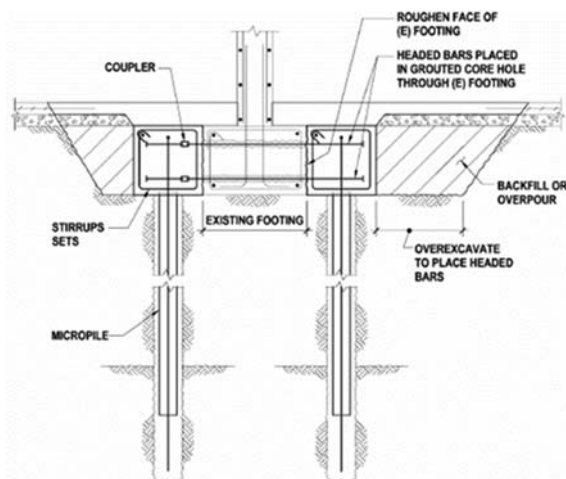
Recalce con micropilotes. Unión encepado-zapata existente mediante armadura pasante [7]
